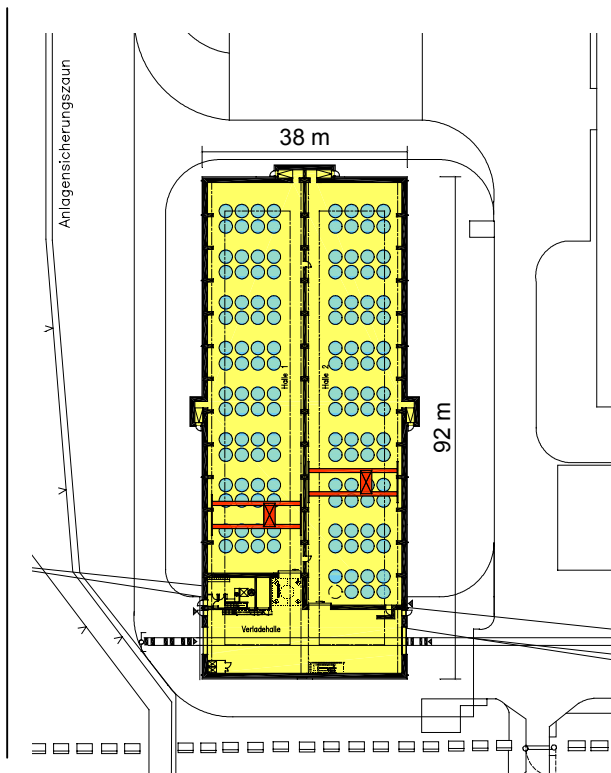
Grundriß des Brennelemente-Zwischenlagers
